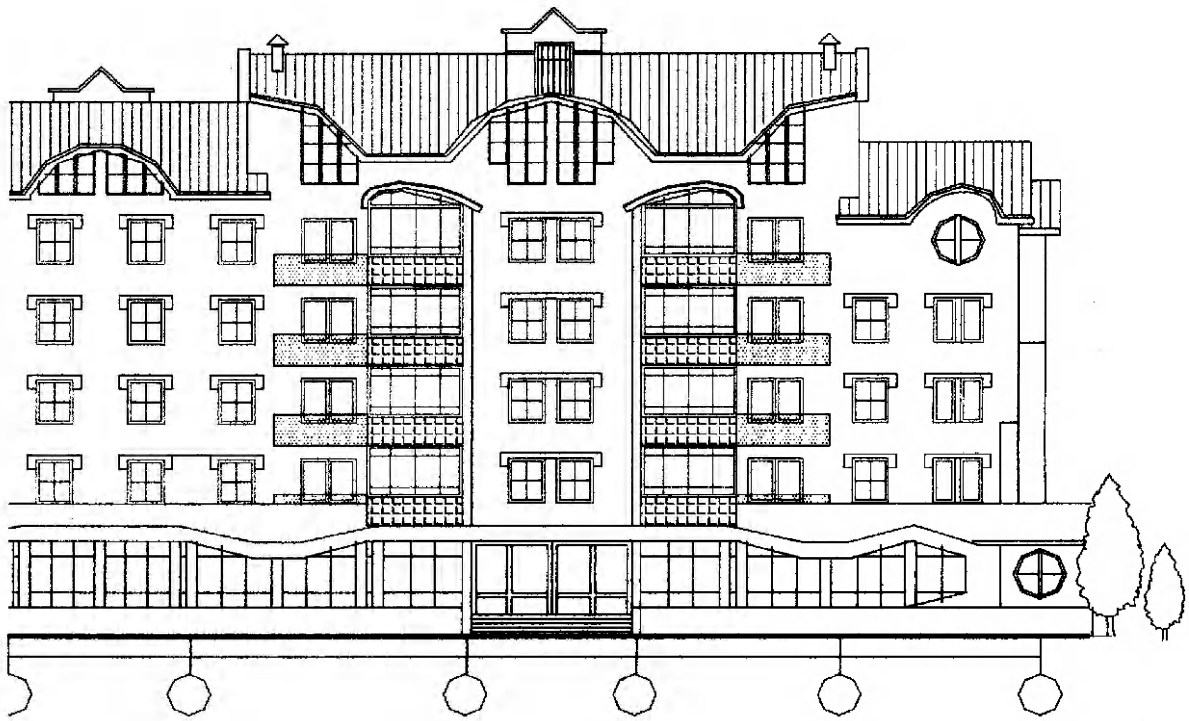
Фрагмент фасада жилого дома переменной этажности
